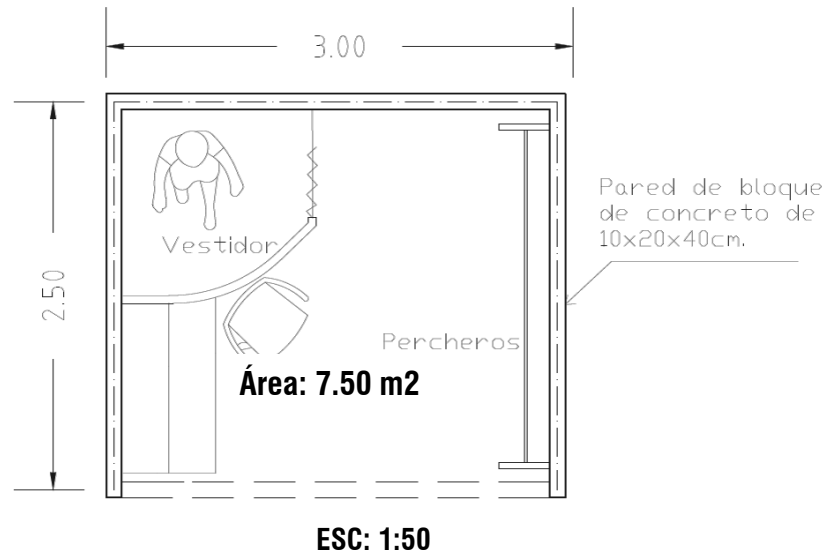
Planta arquitectónica de puestos para ropa y calzado
